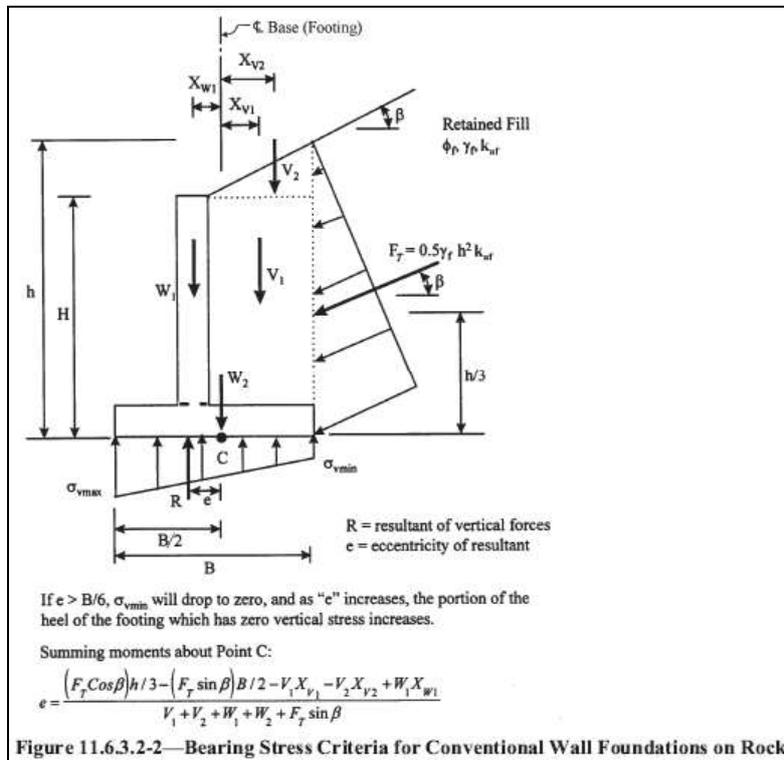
Diagrama de acciones sobre el estribo y la distribución de esfuerzos
